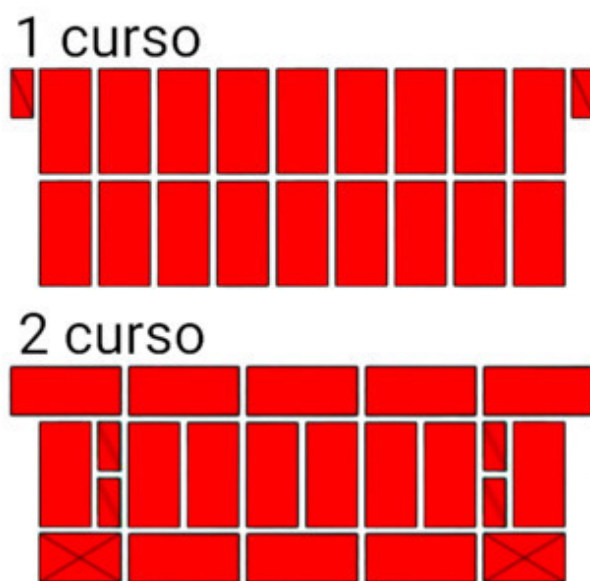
A ordem de colocar tijolos em uma seção de paredes entre as aberturas das janelas. Espessura da parede 2 tijolos.
